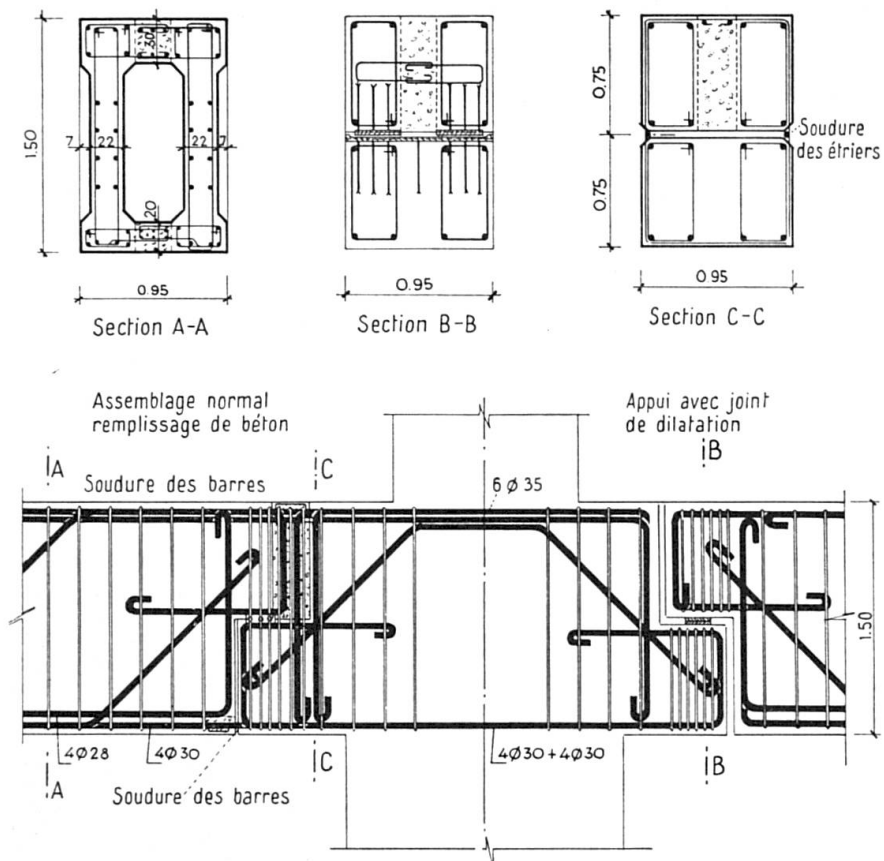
Assemblage de poutres préfabriquées avec des consoles coulées sur place — *Ensidesa* (Avilés).
